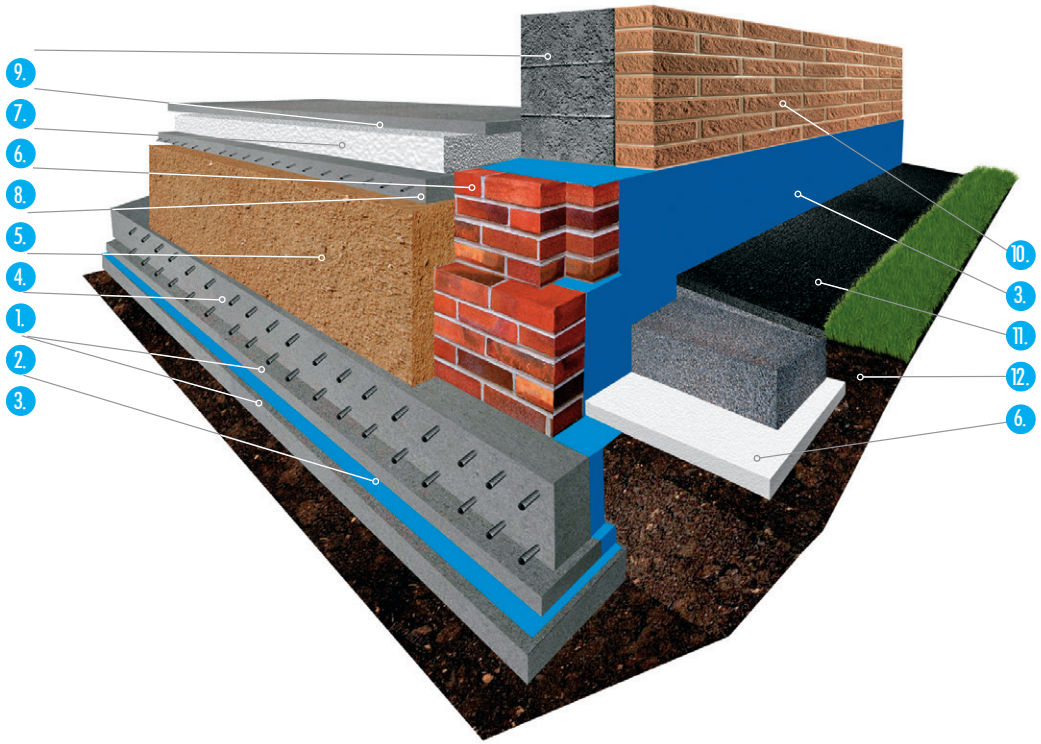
Утепление плитного фундамента пенополистирольными плитами KNAUF Therm® Floor и KNAUF Therm® Фундамент:
